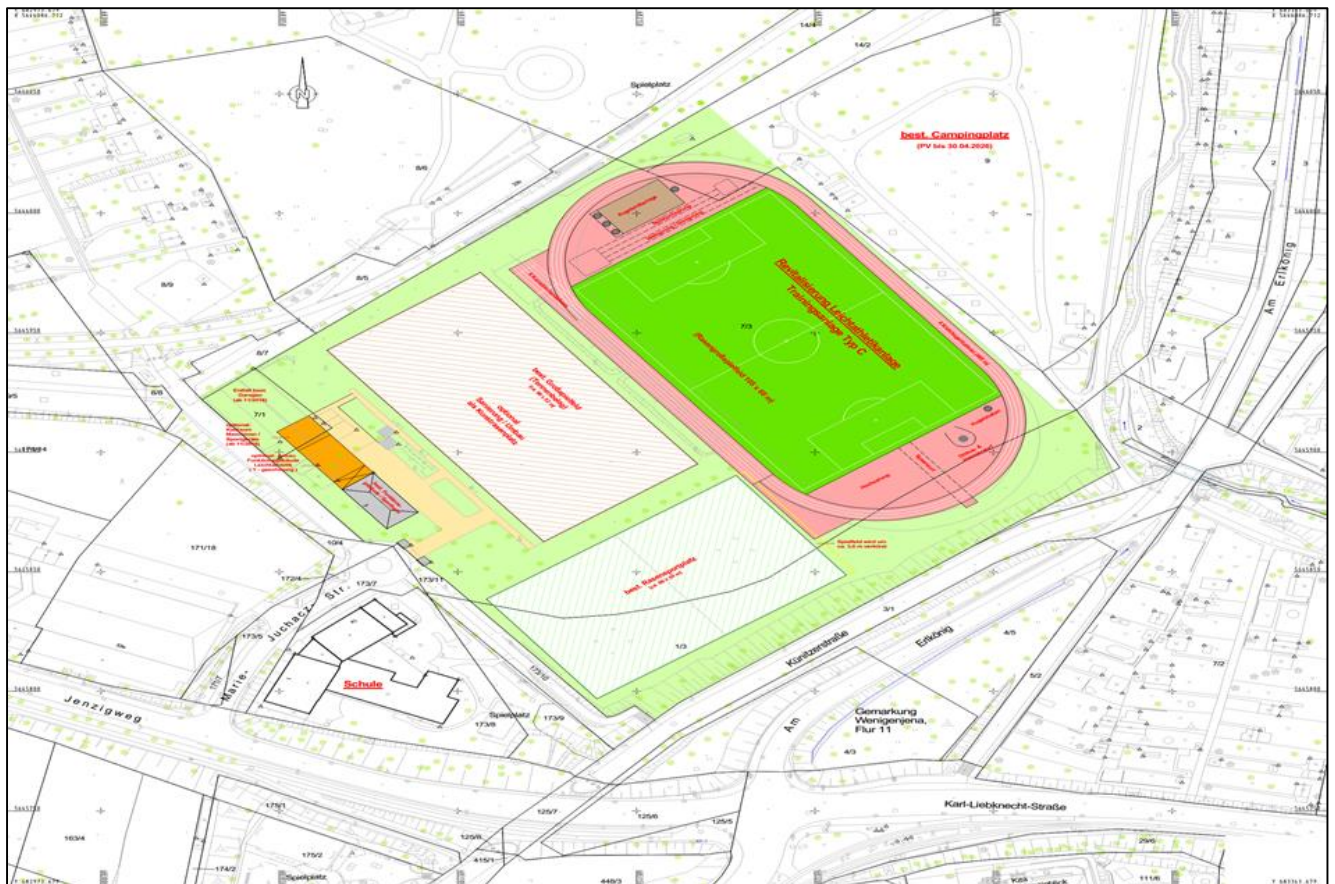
Plan Nr. 1.3 - Lageplan „Jenzigweg“: Variante 1.3, Trainingsanlage Typ C
